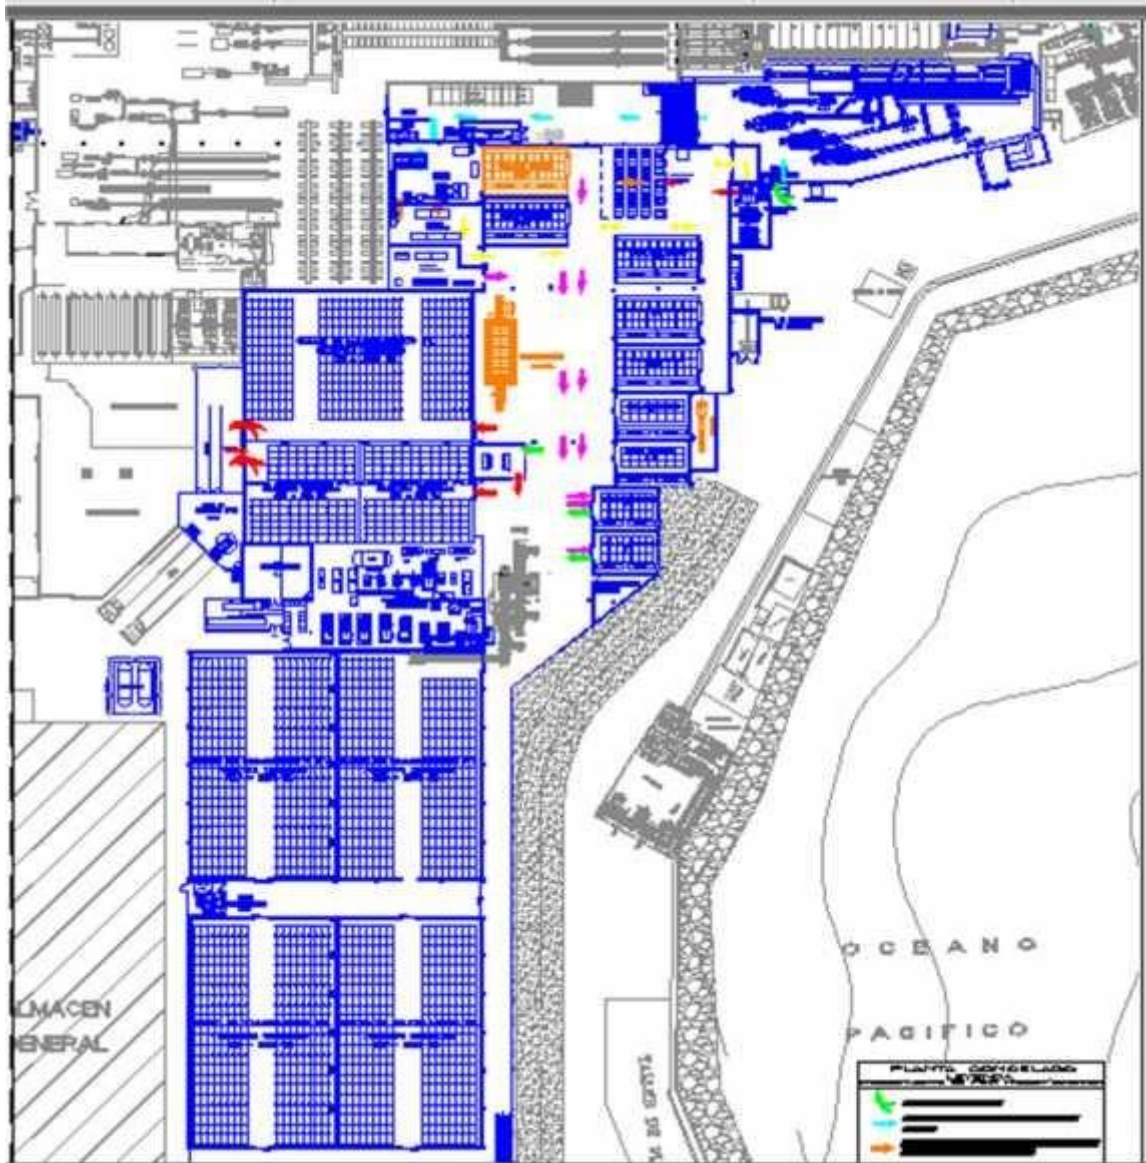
Plano de la Planta de Congelado Austral Group S.A.A. Fuente (Austral Group S.A.A, 2016)
